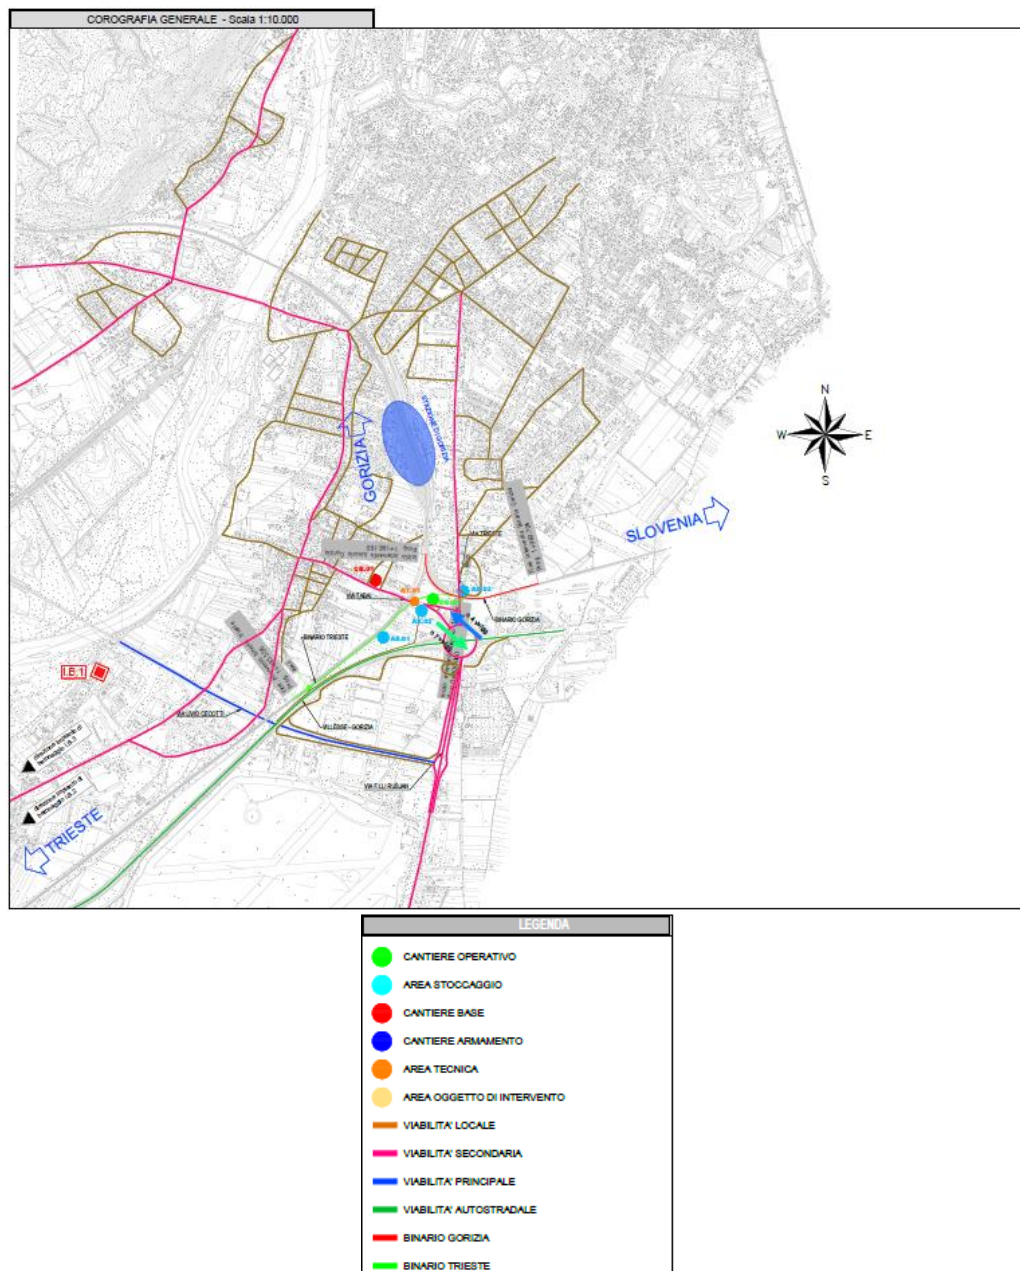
Corografia delle aree di cantiere, della viabilità e ubicazione impianti di betonaggio.
